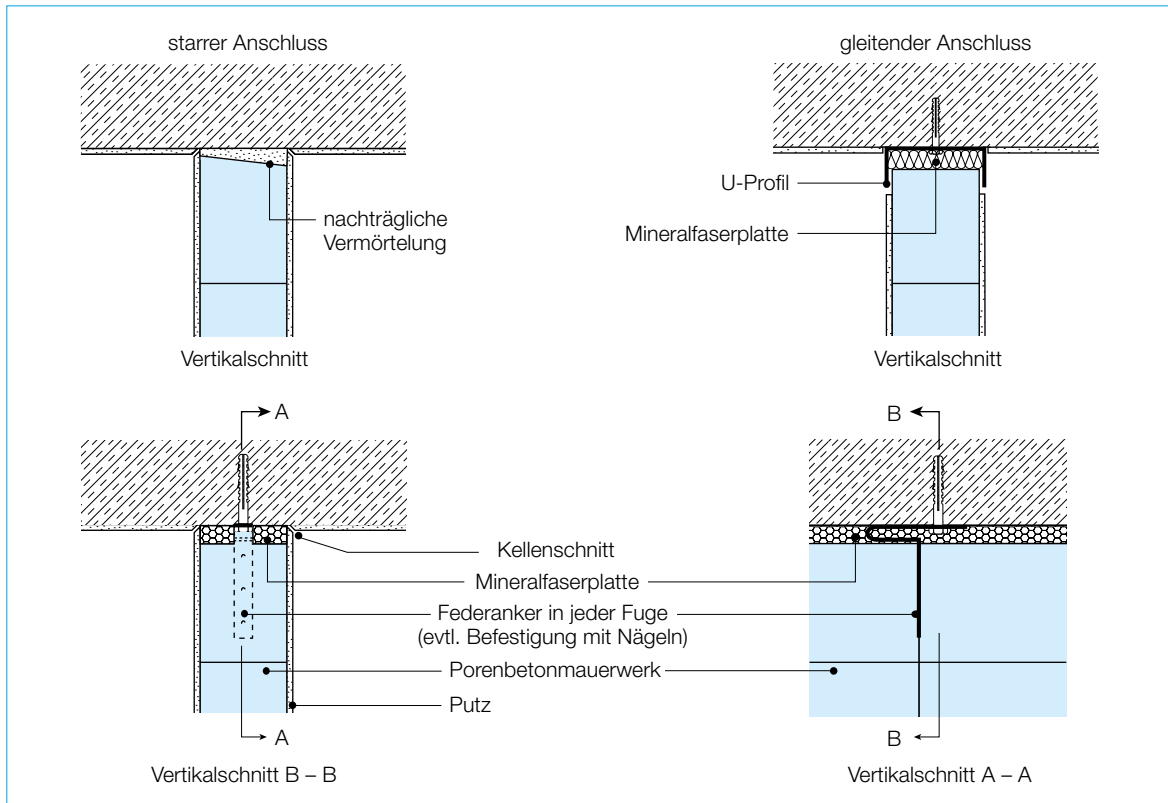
Oberer Anschluss nicht tragender Innenwände aus Porenbetonmauerwerk an eine Stahlbetondecke
